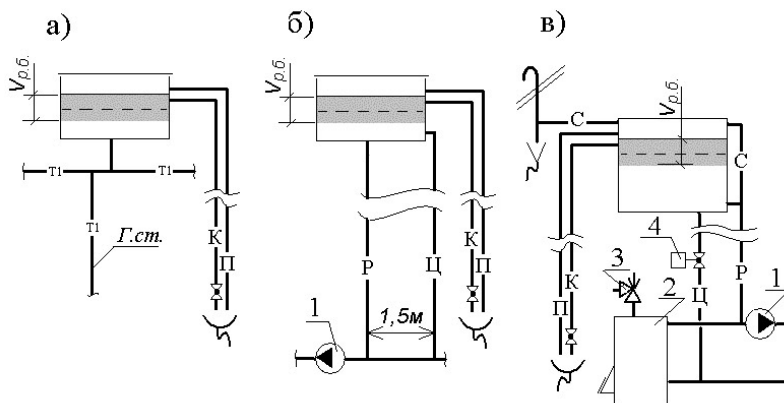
Схемы открытого расширительного бака и его подсоединения к системам
